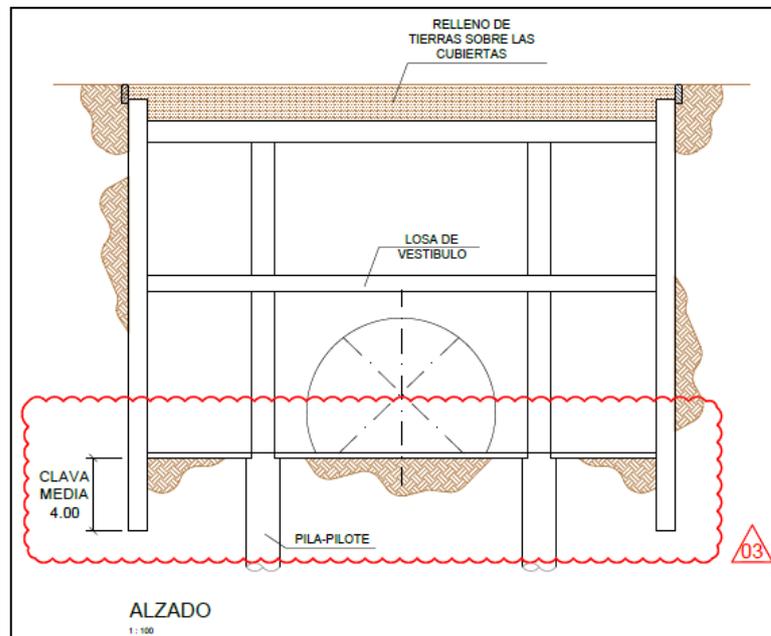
Plano de método constructivo: Sección de corte de relleno sobre Losa Cubierta
